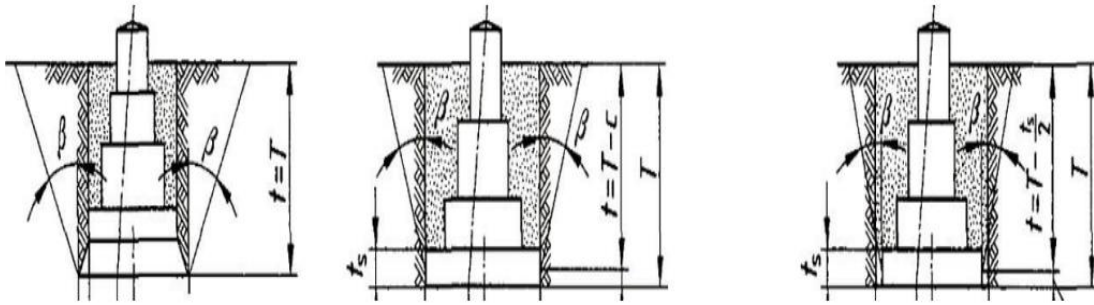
Fondation à redans, fondation bétonnée contre paroi, fondation à coffrage
